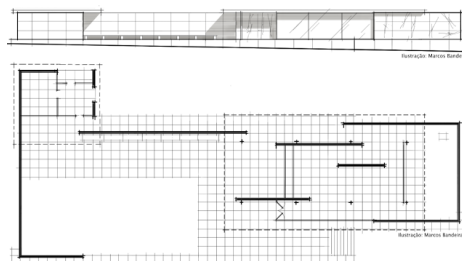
Planta e elevação do Pavilhão de Barcelona.
